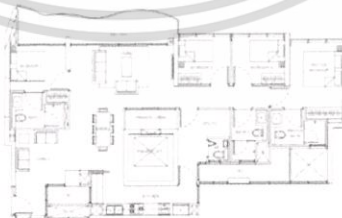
ผังพื้น 3 Bedrooms Plan ที่มา : <http://queens-peak-queenstown.com/>)
